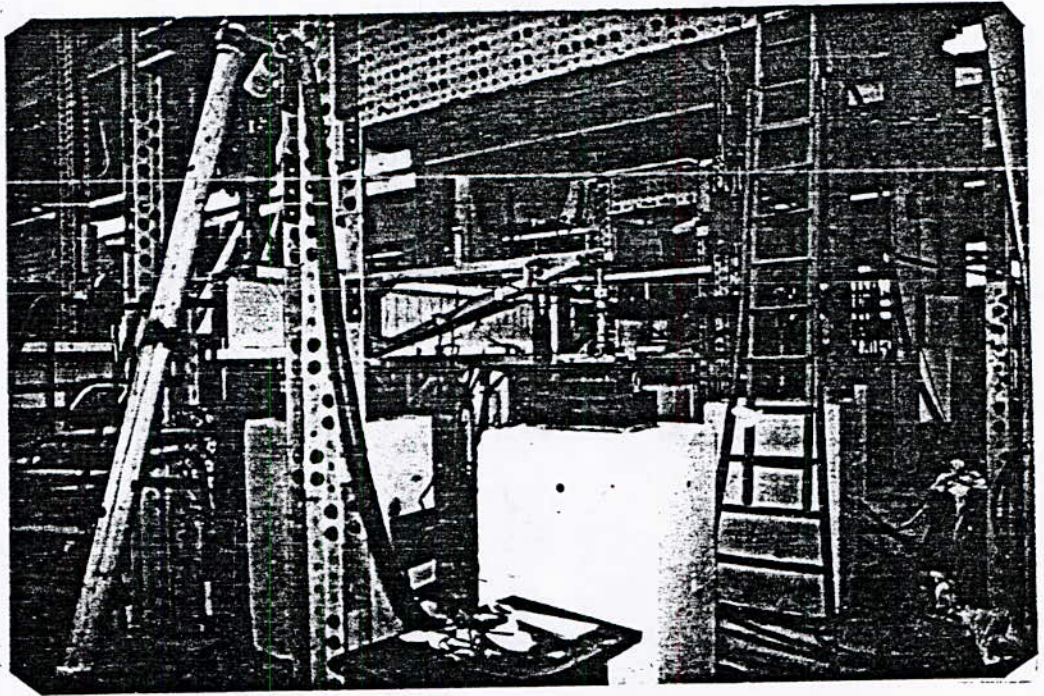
Vue d'ensemble du dispositif d'essai OE 2
